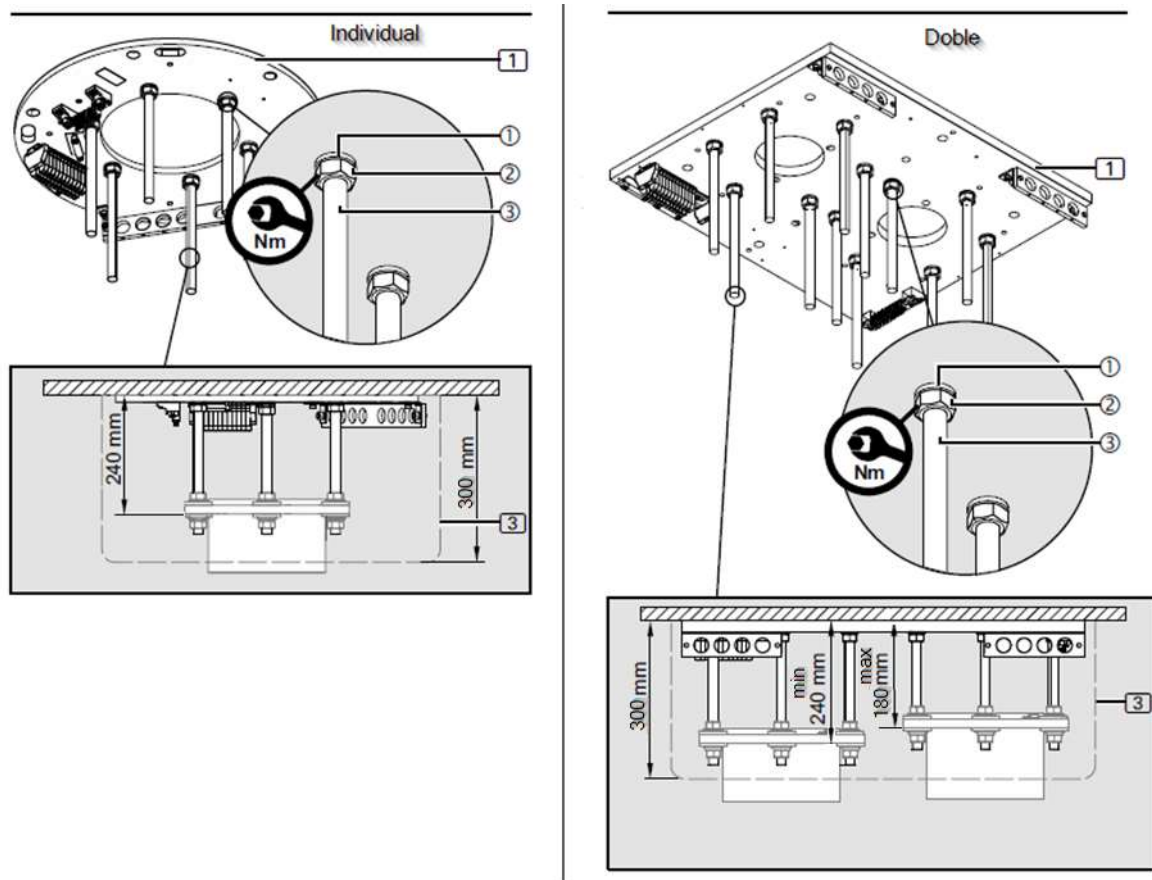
Montage van interfaceplaat zonder verlaagd plafond
